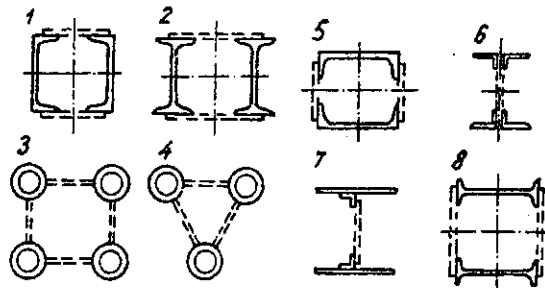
Sơ đồ thanh bụng của vòm rộng
